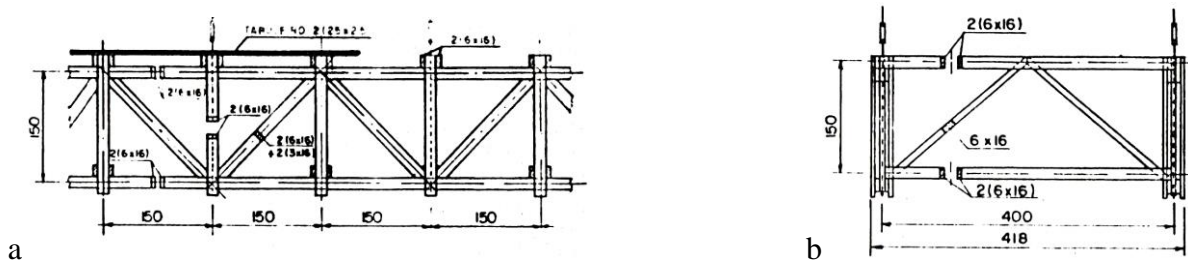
Estrutura de madeira: a) Viga de rigidez treliçada (TR1=TR2); b) Contraventamento transversal das vigas de rigidez. Fonte: (CALIL JUNIOR; ROCCO LAHR; DIAS, 1993)
